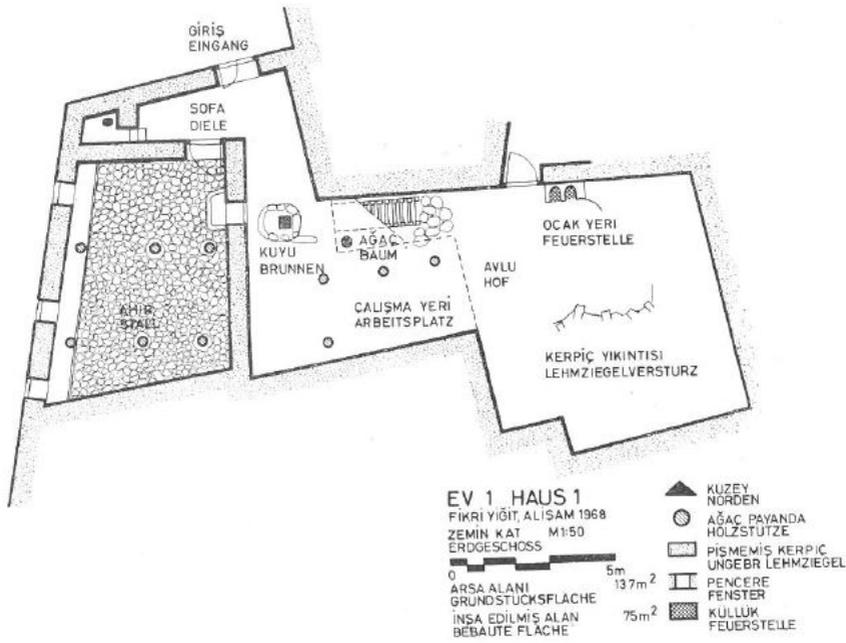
Grundriss Haus 1 mit offener Diele
